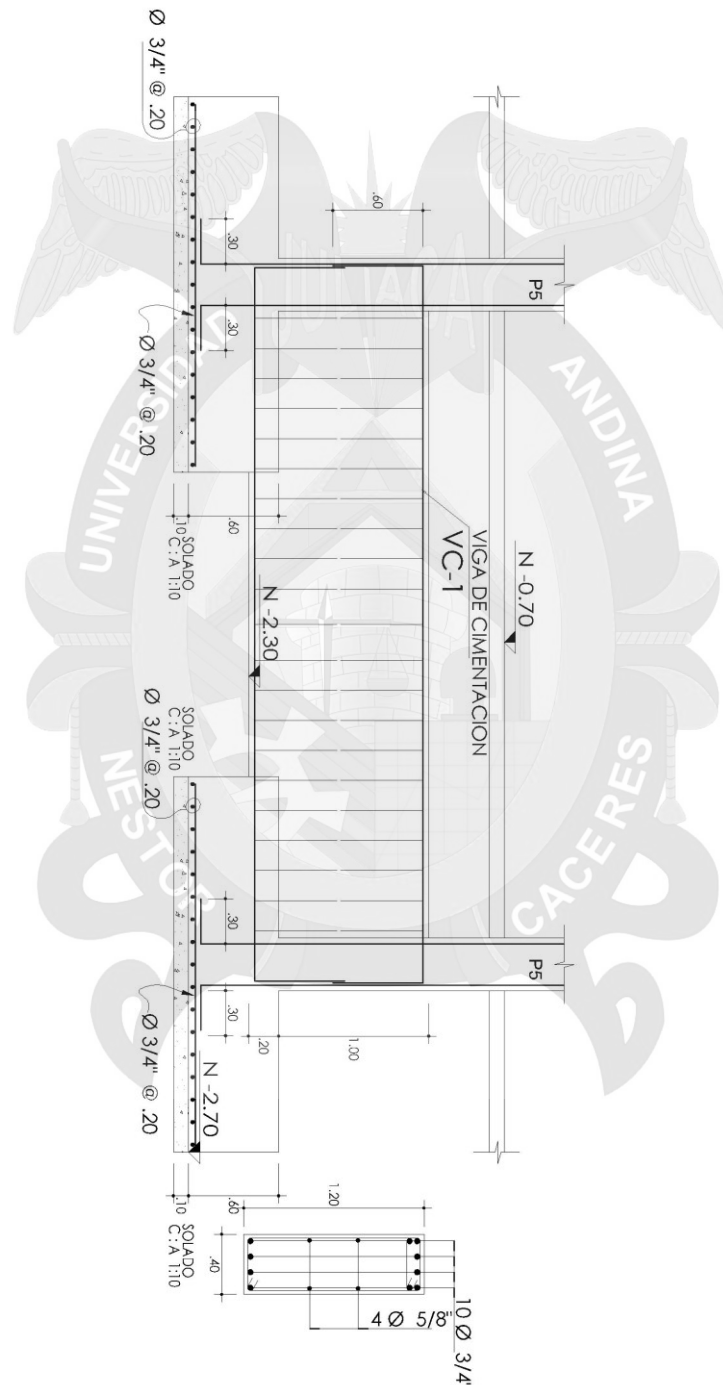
Diseño Final de Viga de Cimentación VC-1.
